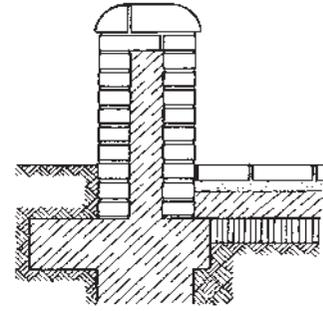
Muro con núcleo de hormigón y cubrición superior con saliente reducido.
